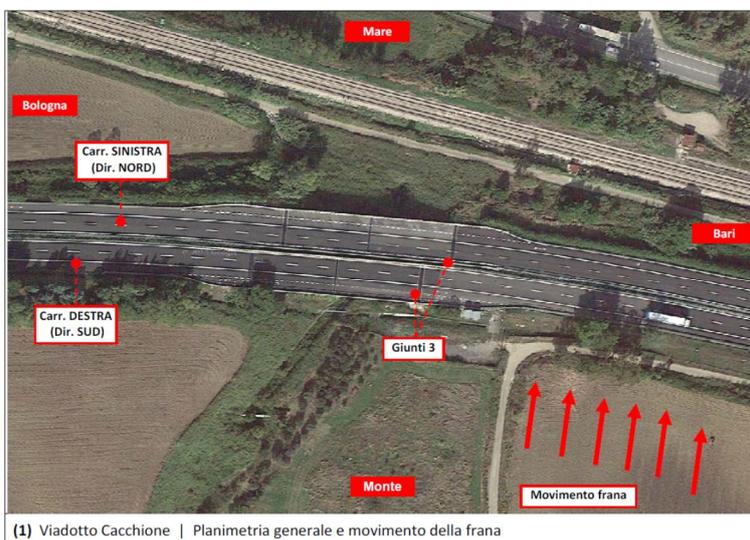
Viadotto Cacchione – Riattivazione 2015: Planimetria generale e movimento della frana
